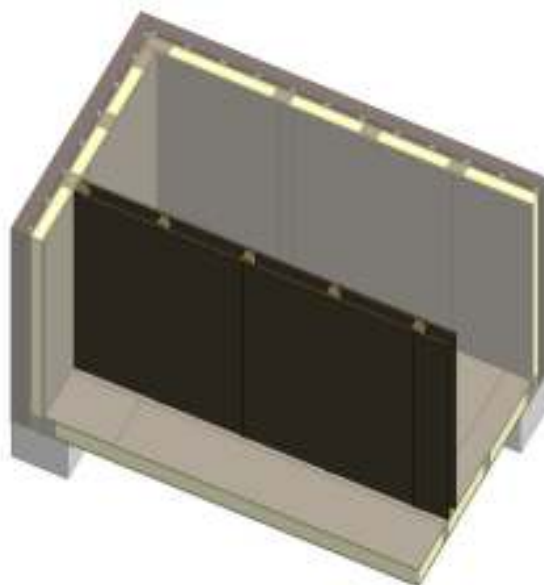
Pormenor de parede interior do módulo tipo.
